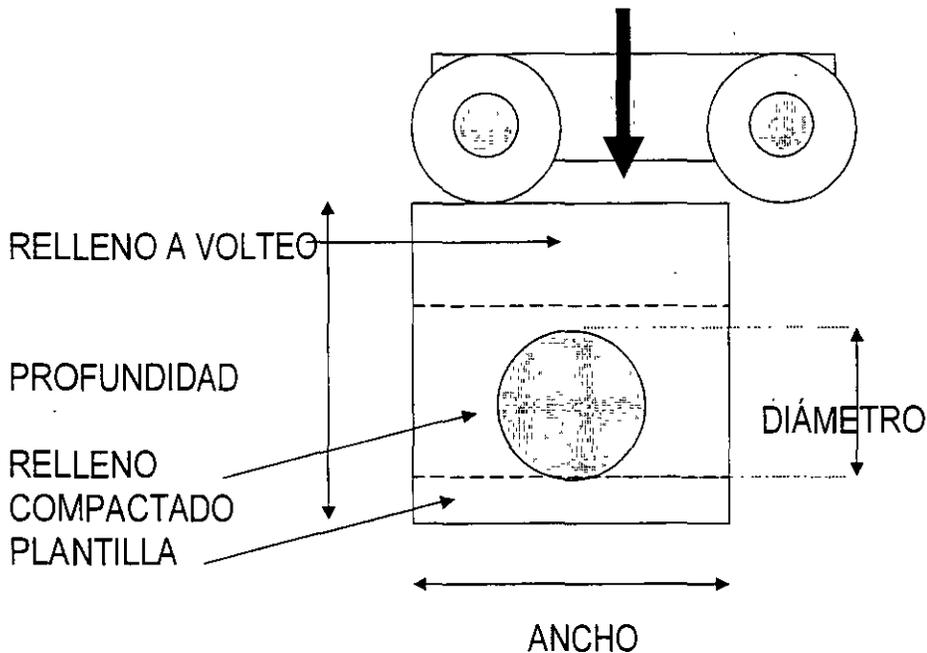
CARACTERÍSTICAS DE LAS ZANJAS
